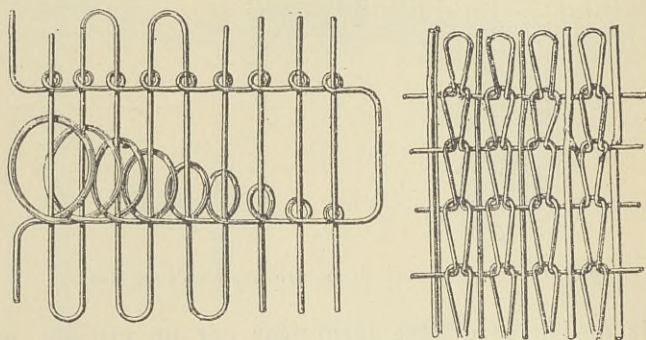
b. — Treillis pour armature de poutre, système Cottancin.
